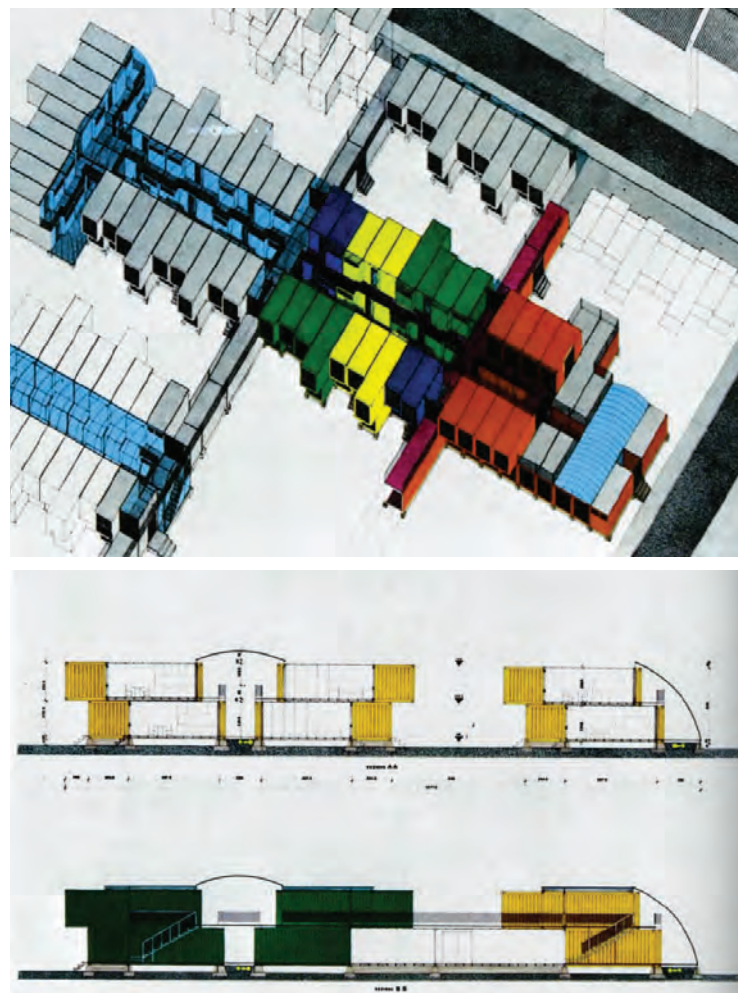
Progetto CON-TE-IN-E.R. Sopra, ipotesi di aggregazione dei moduli abitativi. Sotto, prospetti e sezioni dei moduli aggregati.
